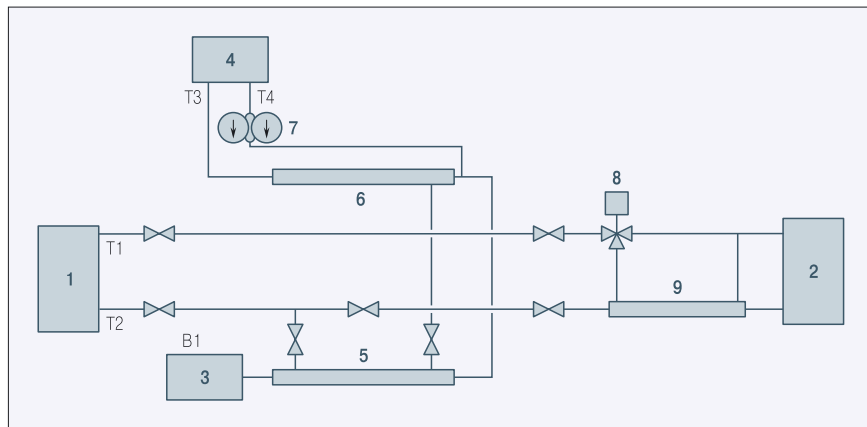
Принципиальная схема ЦТП с рекуперативным теплообменником (1 — городская теплосеть от котельной; 2 — квартальная теплосеть к системам отопления зданий; 3 — городской водопровод; 4 — квартальная теплосеть к системам ГВС зданий; 5, 6 — водоподогреватели ГВС первой и второй ступени; 7 — циркуляционный насос системы ГВС; 8 — трехходовой поворотный клапан; 9 — рекуперативный теплообменник)
